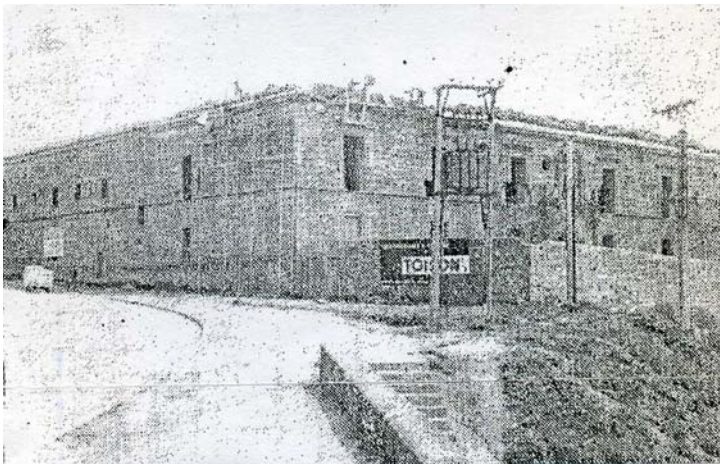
Campus de Educación: estado de la zona sur hacia 1970.
